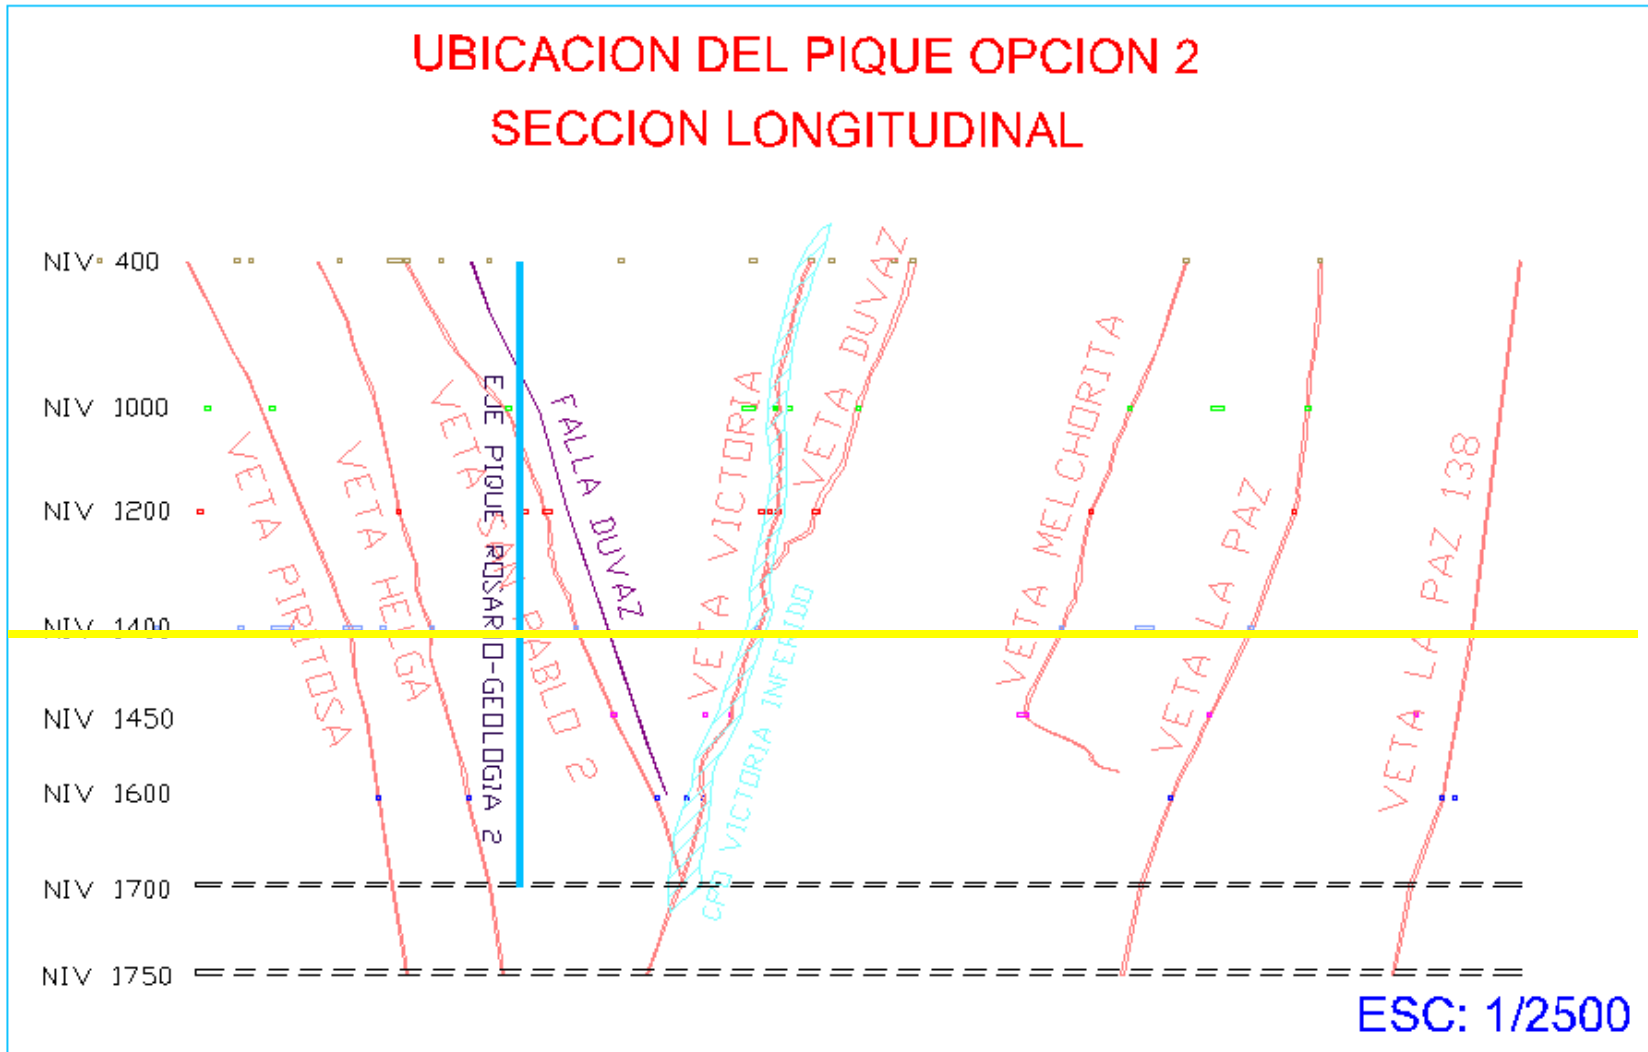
Plano de Ubicación de Pique Central – Opción 2
